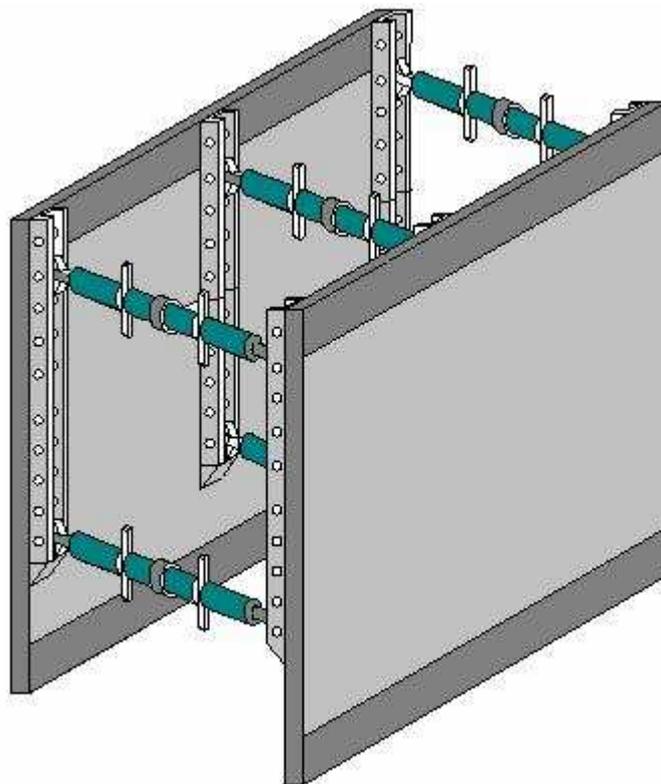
Vista en Isométrica del modulo ensamblado del Sistema de Cajones./Elaboración Propia.
